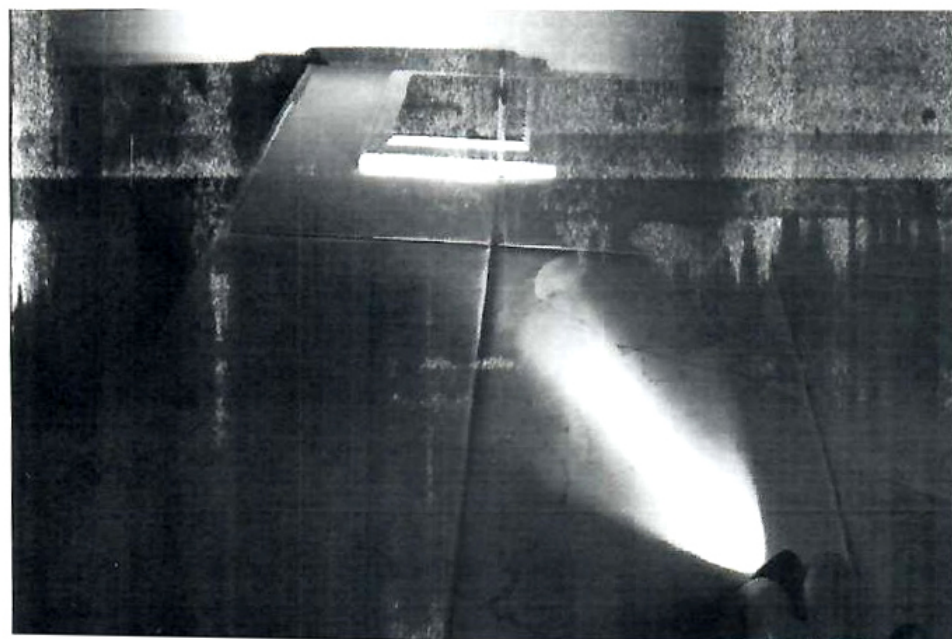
Перепады между элементами облицовки стен (керамическая плитка)
